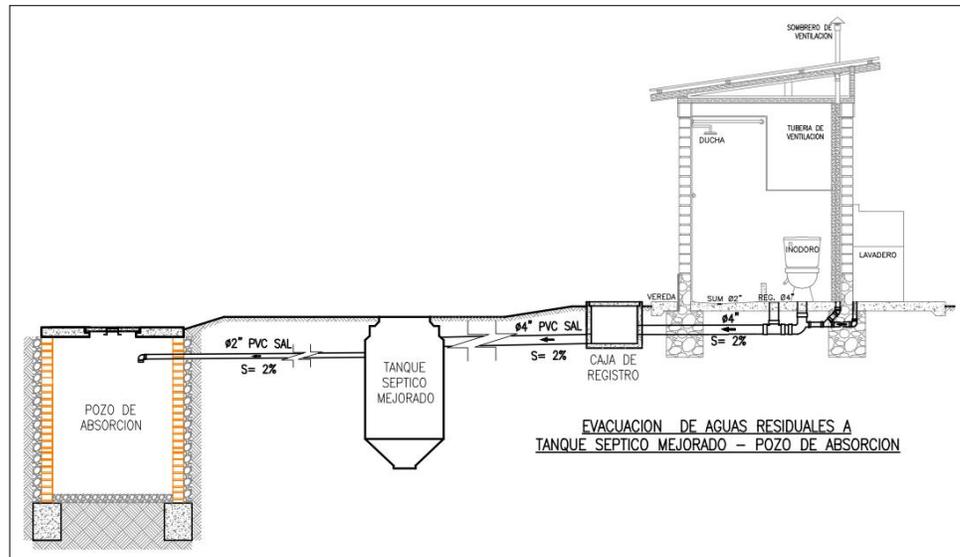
Vista en corte de los componentes de la UBS con arrastre hidráulico.
